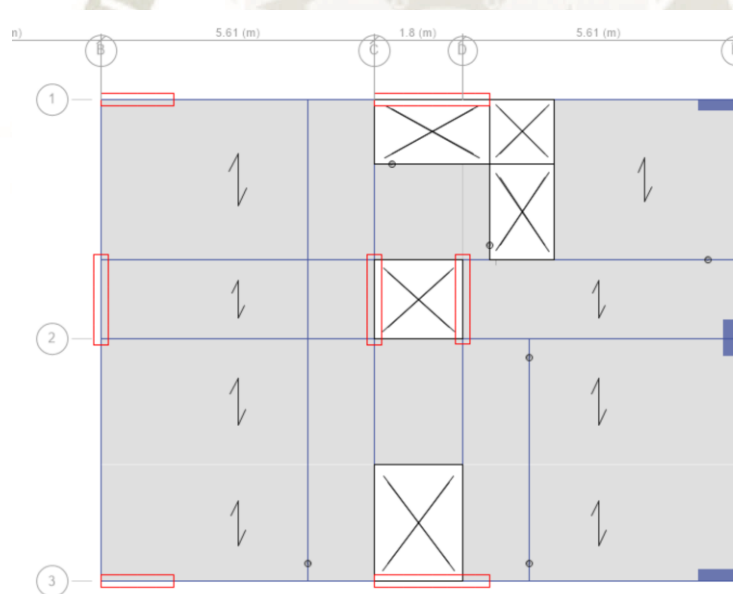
Planta de nivel 1 a 5 en Etabs
